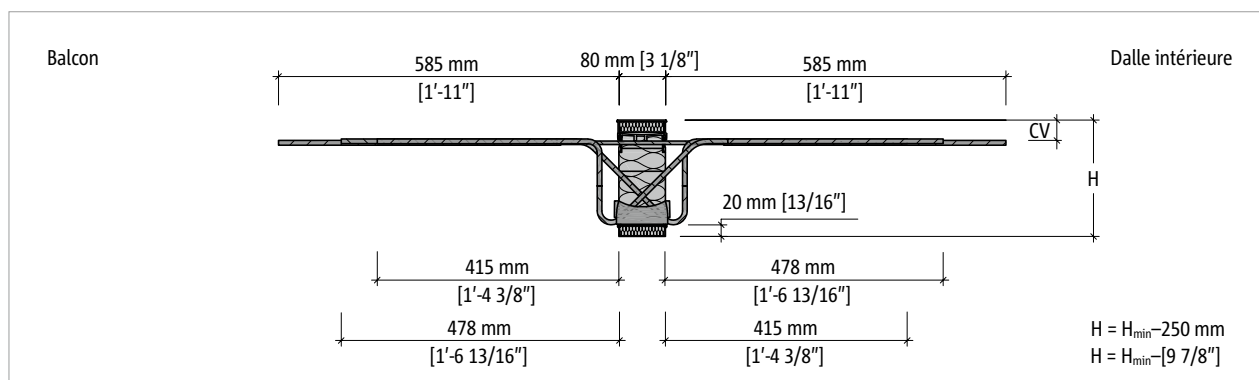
Schöck Isokorb® T Type CK-M4-VV1 à M5-VV1 : coupe transversale du produit
